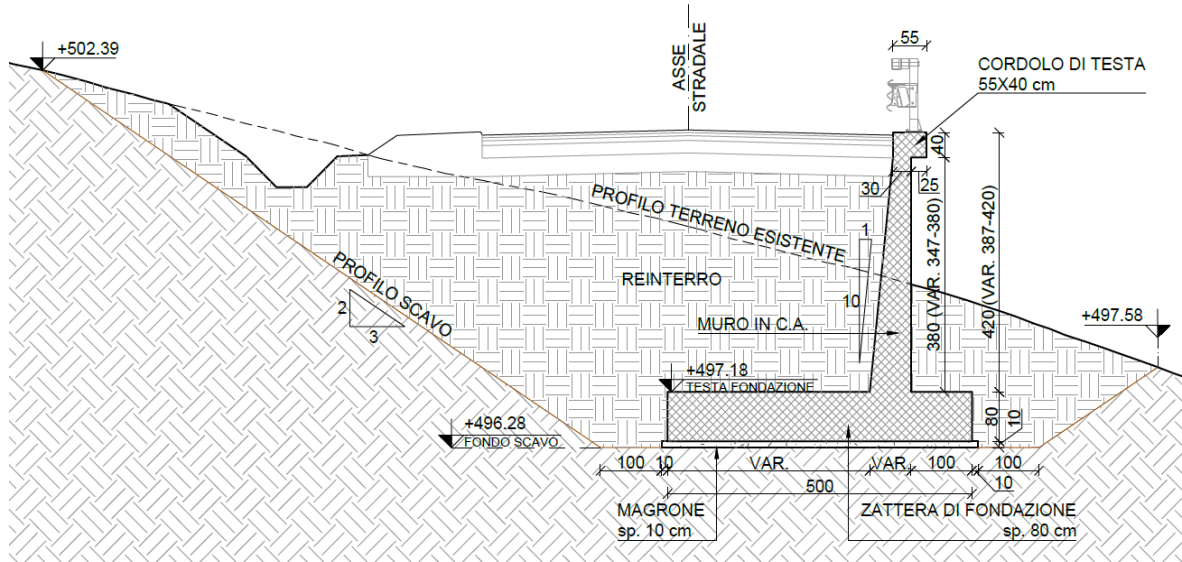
Sezione muro di sostegno viabilità NV19 (MU03)
